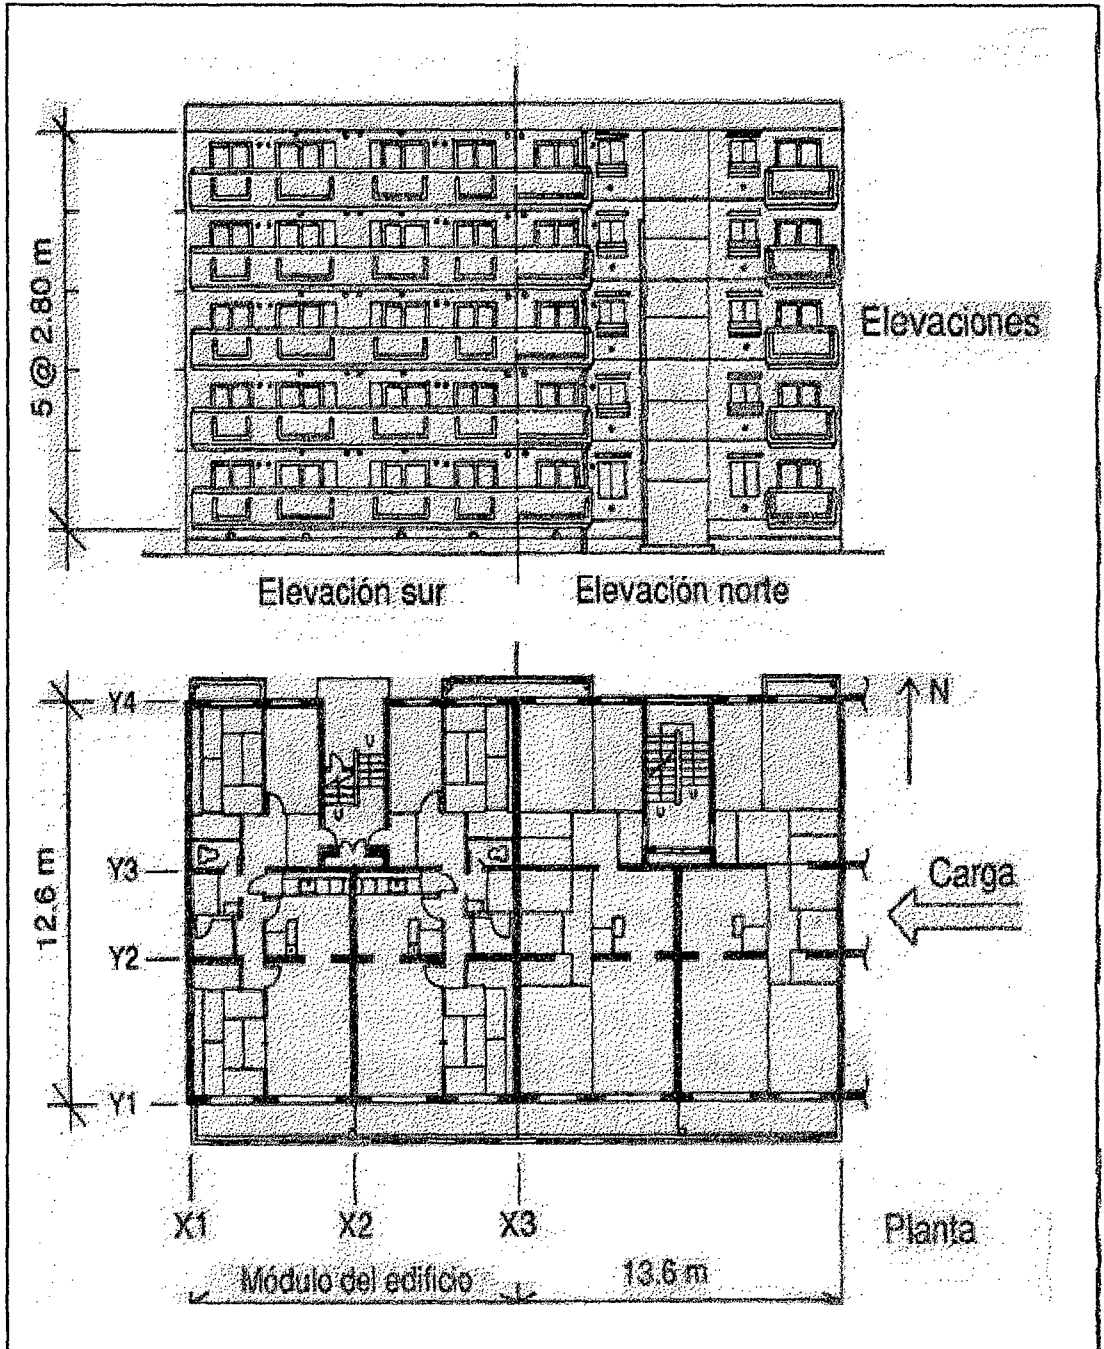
Planos de Elevación y Planta del Módulo del edificio.
